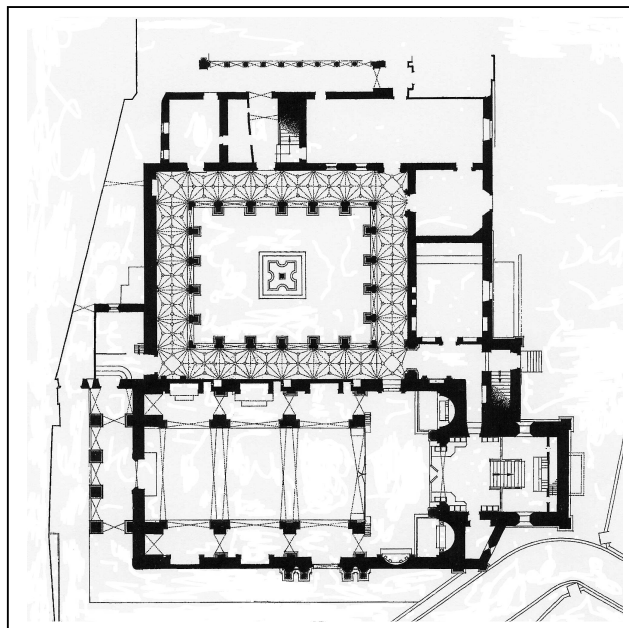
Planta da igreja e do claustro (S. Gonçalo - Amarante)
